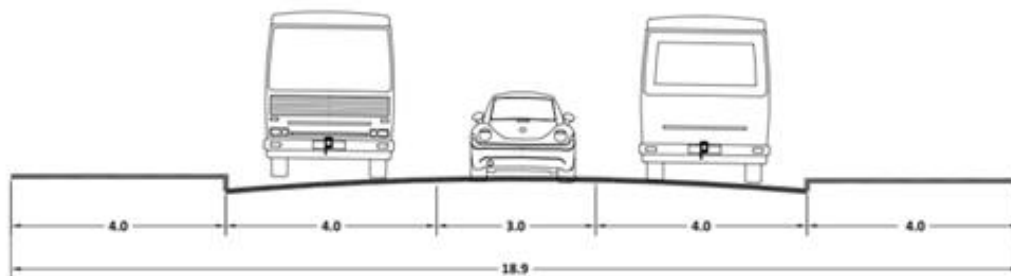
Perfil Transversal proposto para Rua do Acampamento
